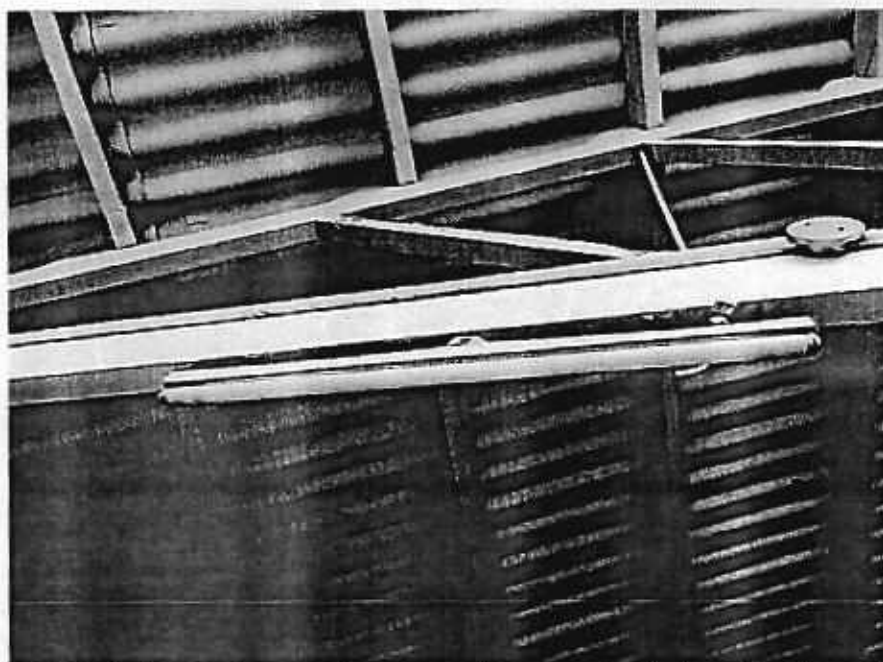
Vista de lámpara fluorescente en Lavandería sin canastilla de protección o cubierta.
